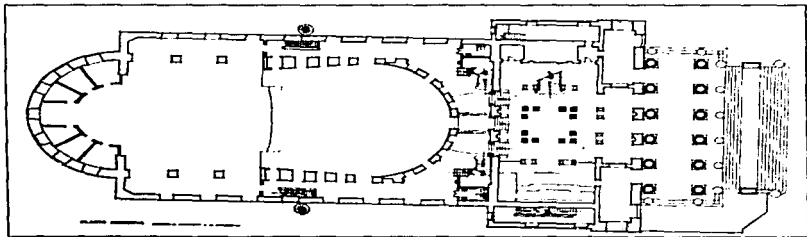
(02) Planta Teatro Juárez, Guanajuato, Guanajuato.
